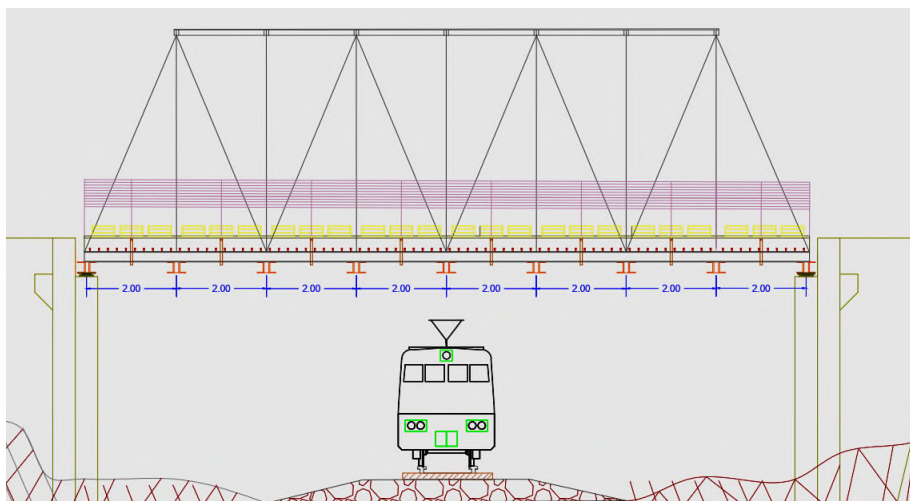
Seccao longitudinal. Fonte (Autor)
